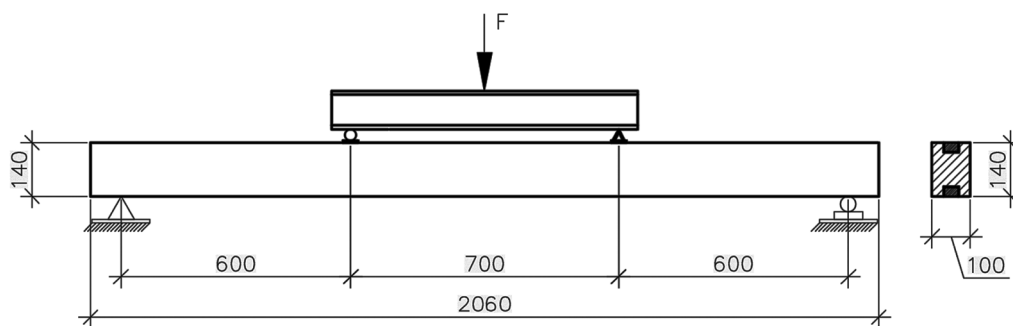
Конструктивная схема испытательного стенда армированной балки
